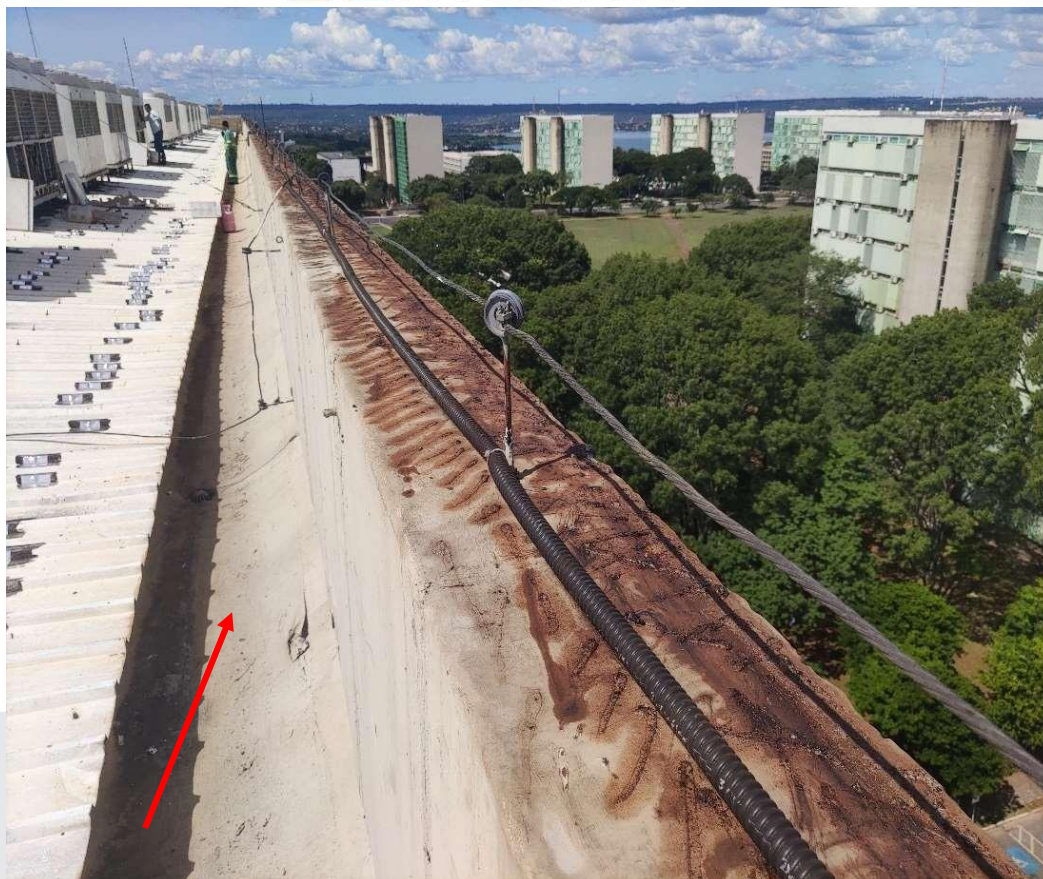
Sistema de impermeabilização em estado avançado de degradação
